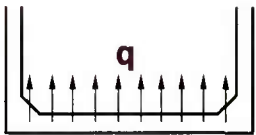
Poussée au vide d'un hourdis courbe - coupe transversale
